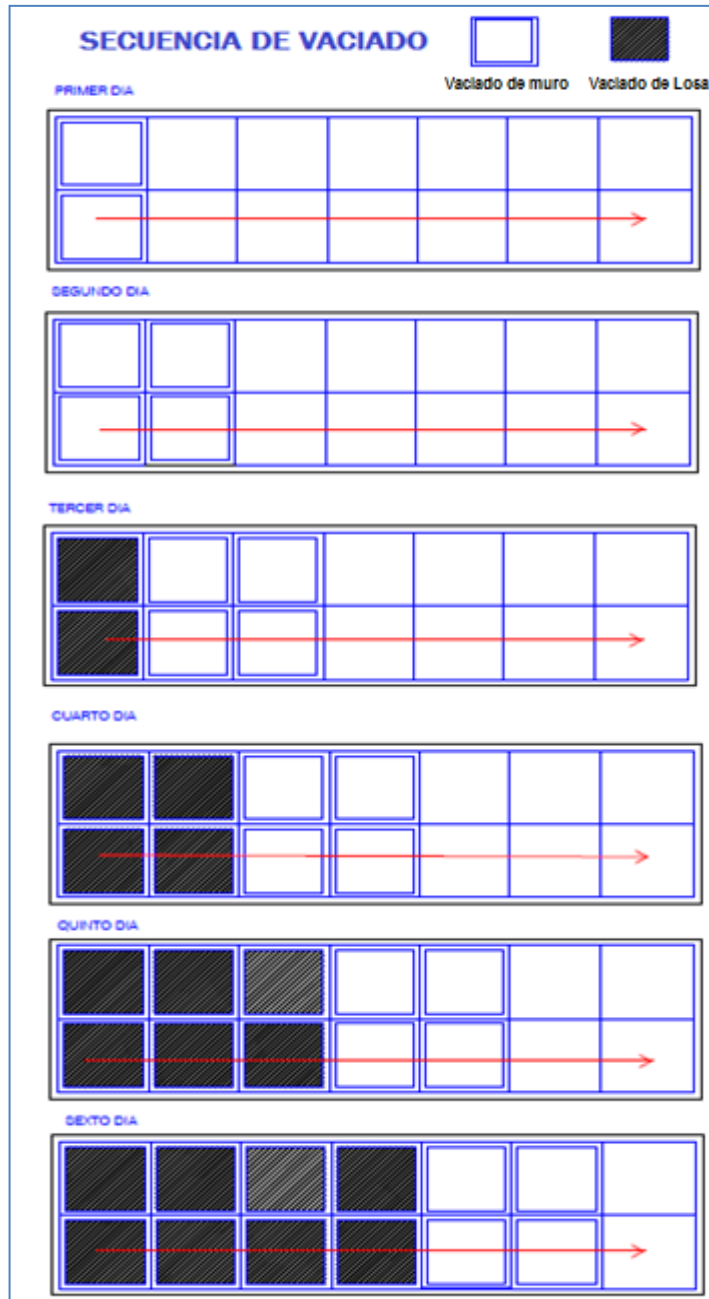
Vista en Planta: Secuencia de Vaciado - Obra La Campiña.
